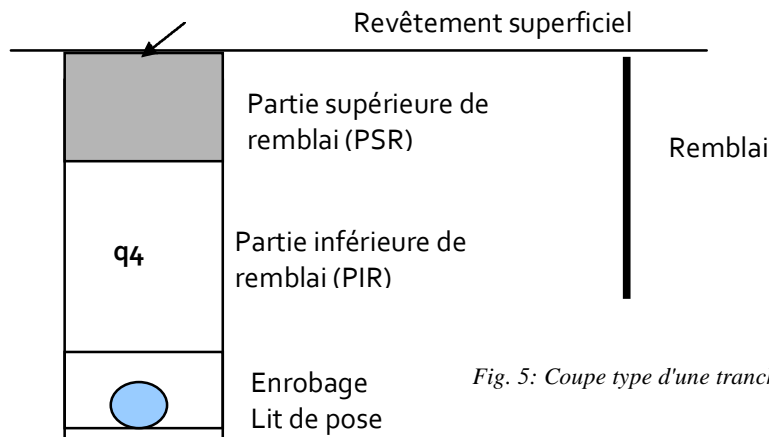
Coupe type d'une tranchée sous trottoir ou piste cyclable
